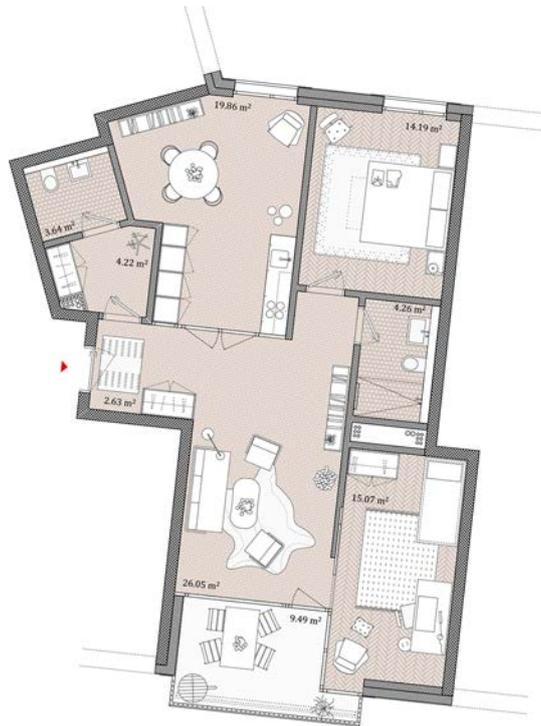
Wohnungsgrundriss 3.5 Zimmer - Whg.
